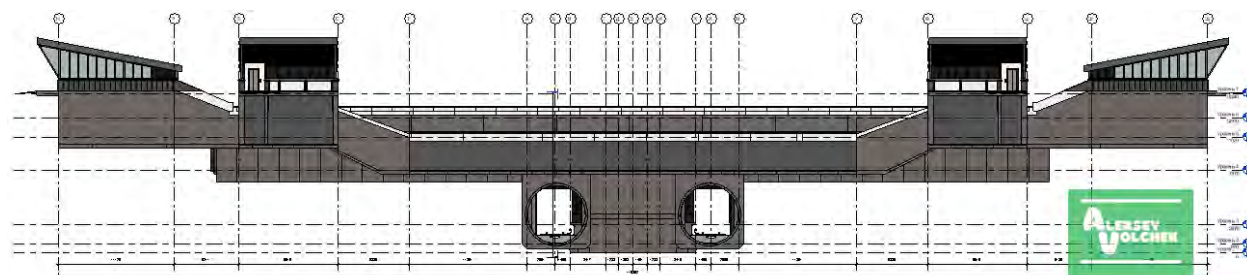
Архитектурно-планировочное решение (фасад - северный)
